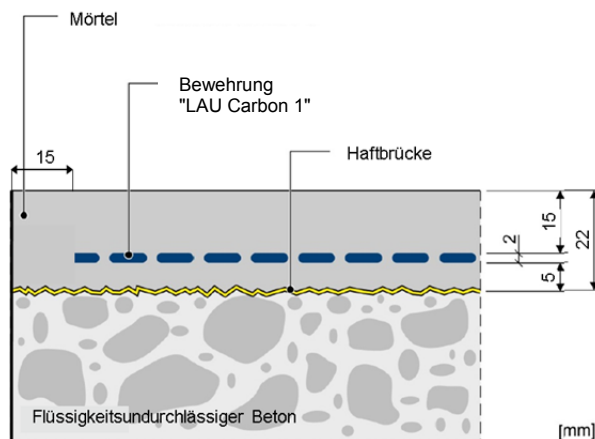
Beispielhafter Einbau des Carbonbetonsystems für eine Flüssigkeit mit  $e_{tk} = 13$  mm mit einer Lage textiler Bewehrung
